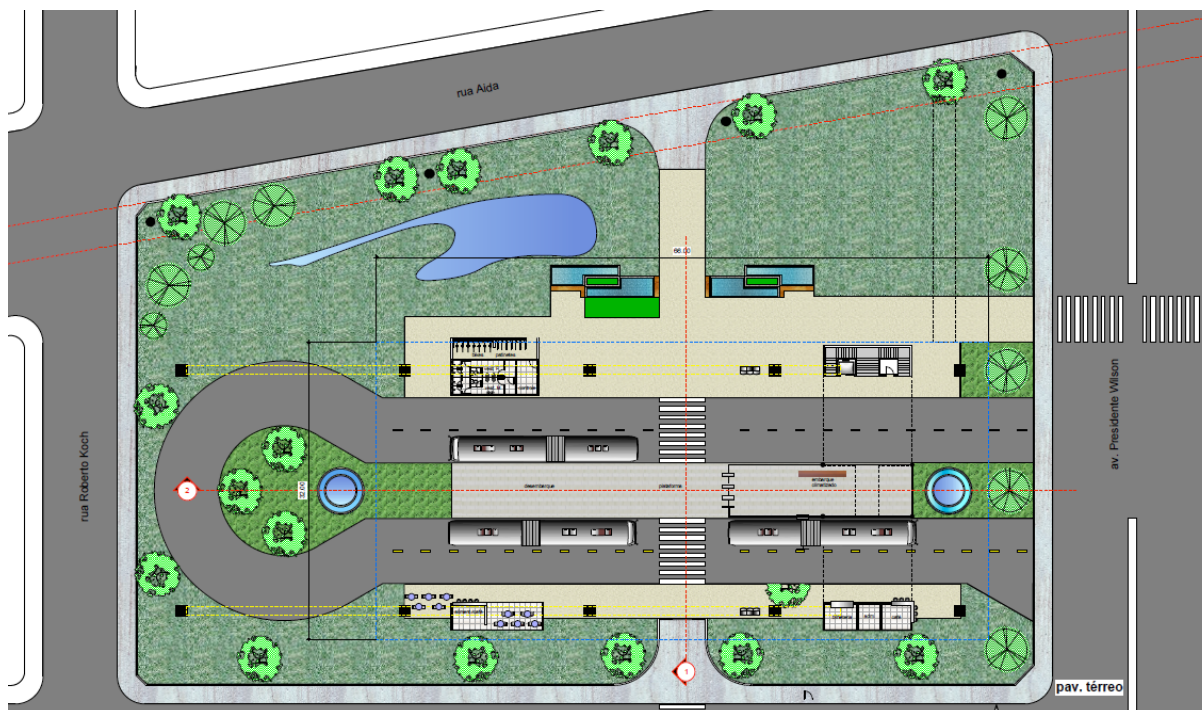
Terminal Tamanduateí - Proposta – Planta
